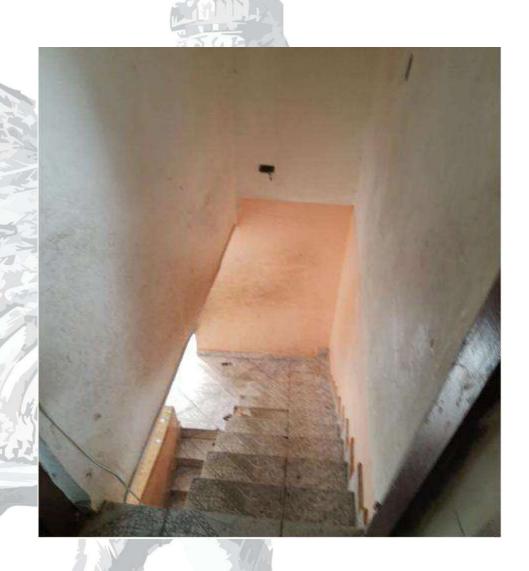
FOTO ESCADA QUE LEVA AO NIVEL SUPERIOR
